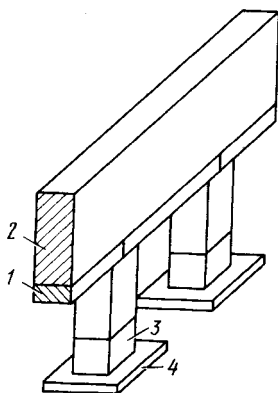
Отдельные (столбчатые) фундаменты под стены бескаркасных зданий:
